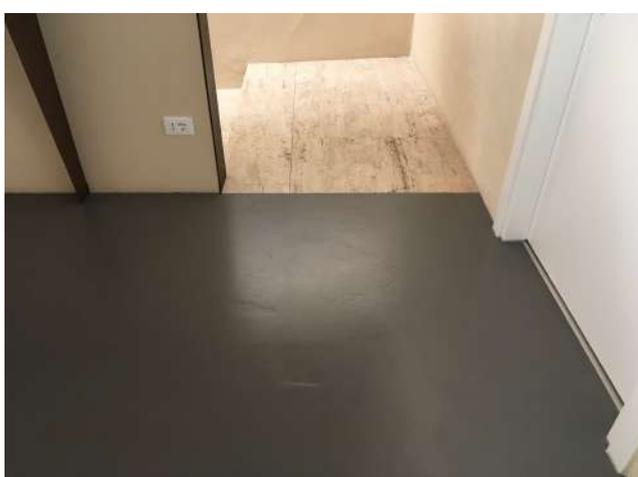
Contrasto cromatico tra la pavimentazione del primo piano e la scala.
